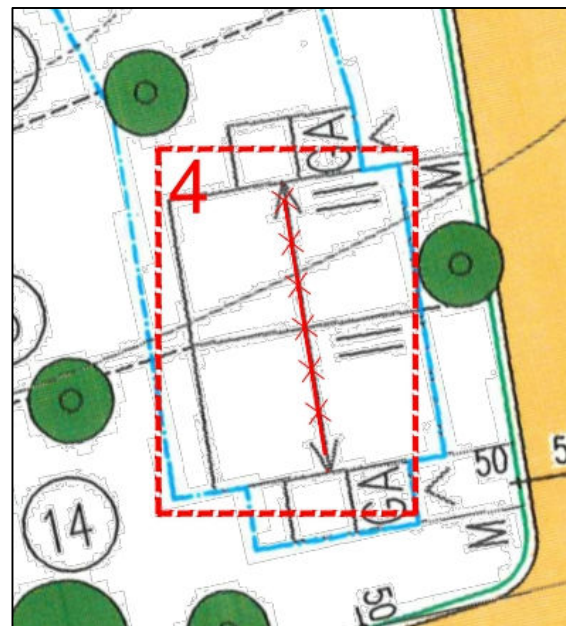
Auszug 2. Änderung B-Plan – Firstrichtung
